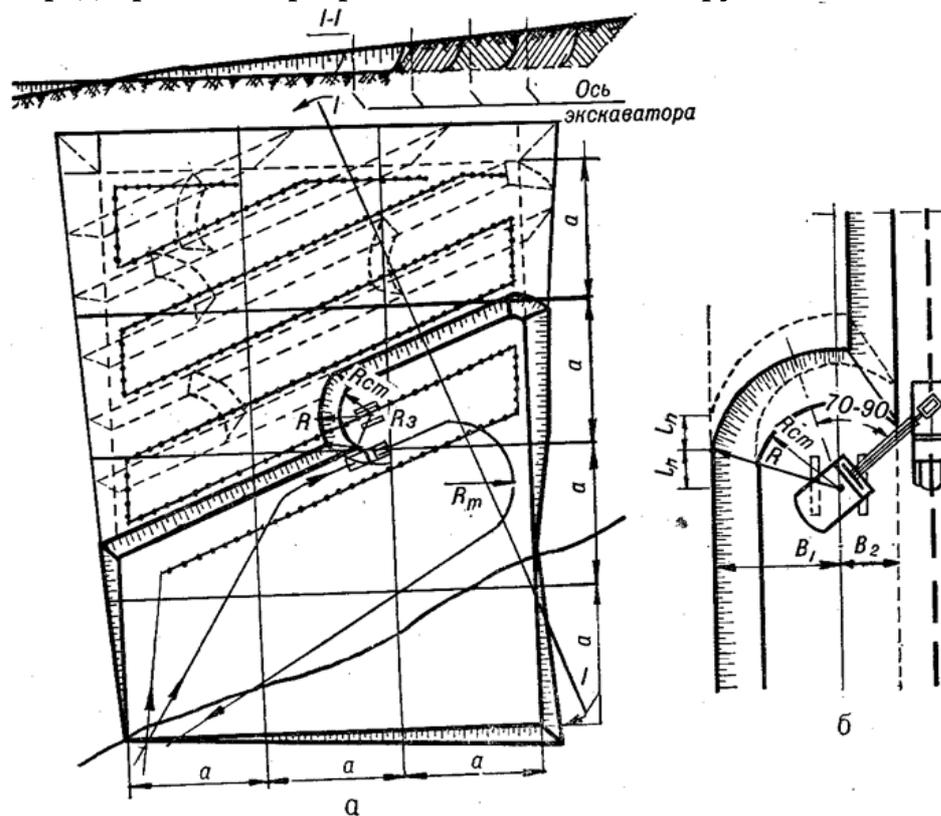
Схема разработки грунта экскаватором боковыми проходками
